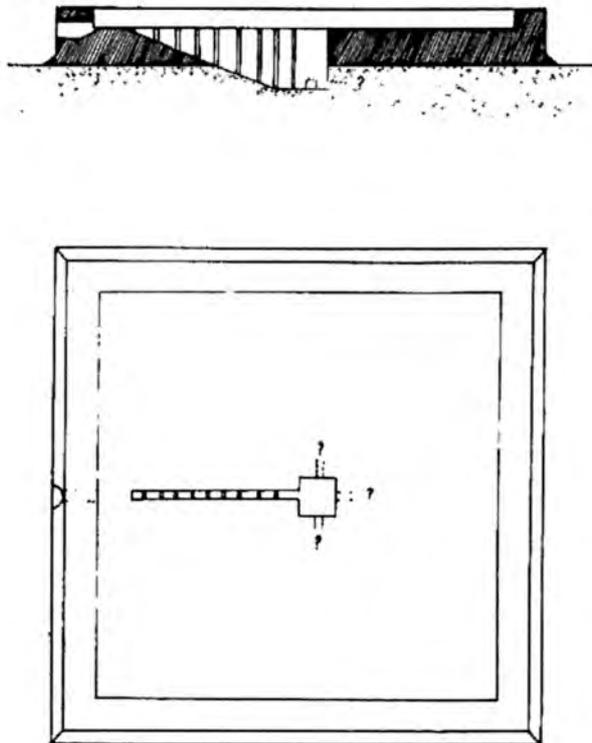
Grundriss und Schnitt der Pyramide des Chui
